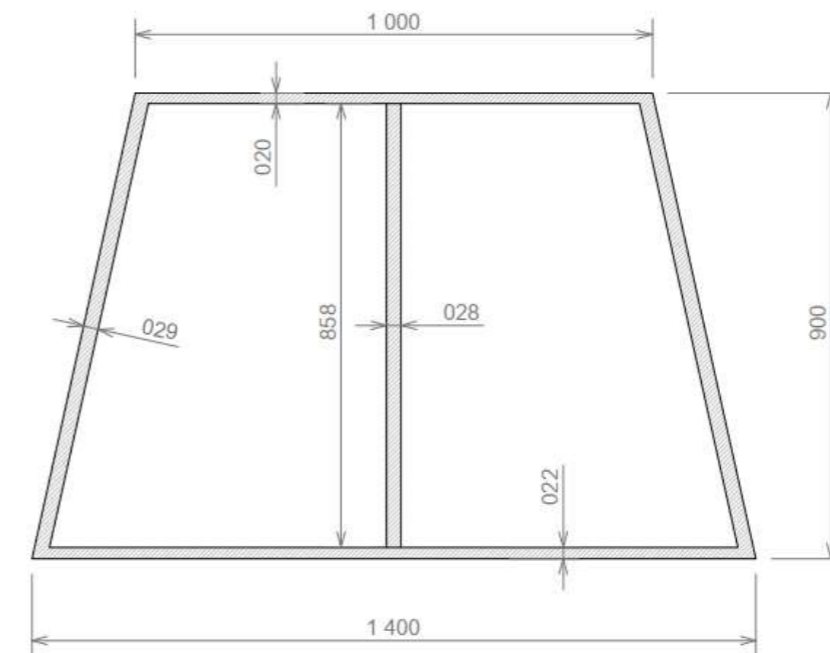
Sección transversal de las vigas longitudinales (fuente: elaboración propia)
